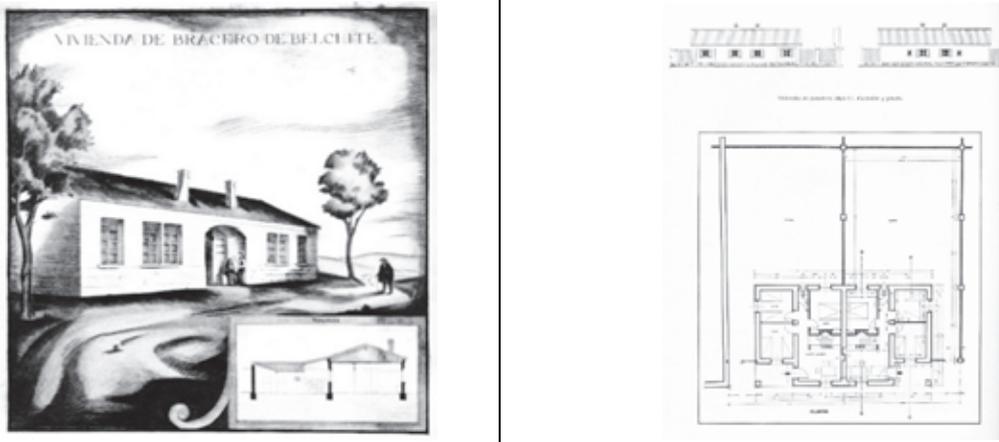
Grabado y plano de los proyectos de vivienda para jornalero de la DGRDR en Belchite (Zaragoza) y en Gajanejos (Guadalajara), respectivamente. Fuente: (izquierda) *Reconstrucción*, 3 (1940), s.p.; (derecha) Ruiz Larrea, 1940: 26
